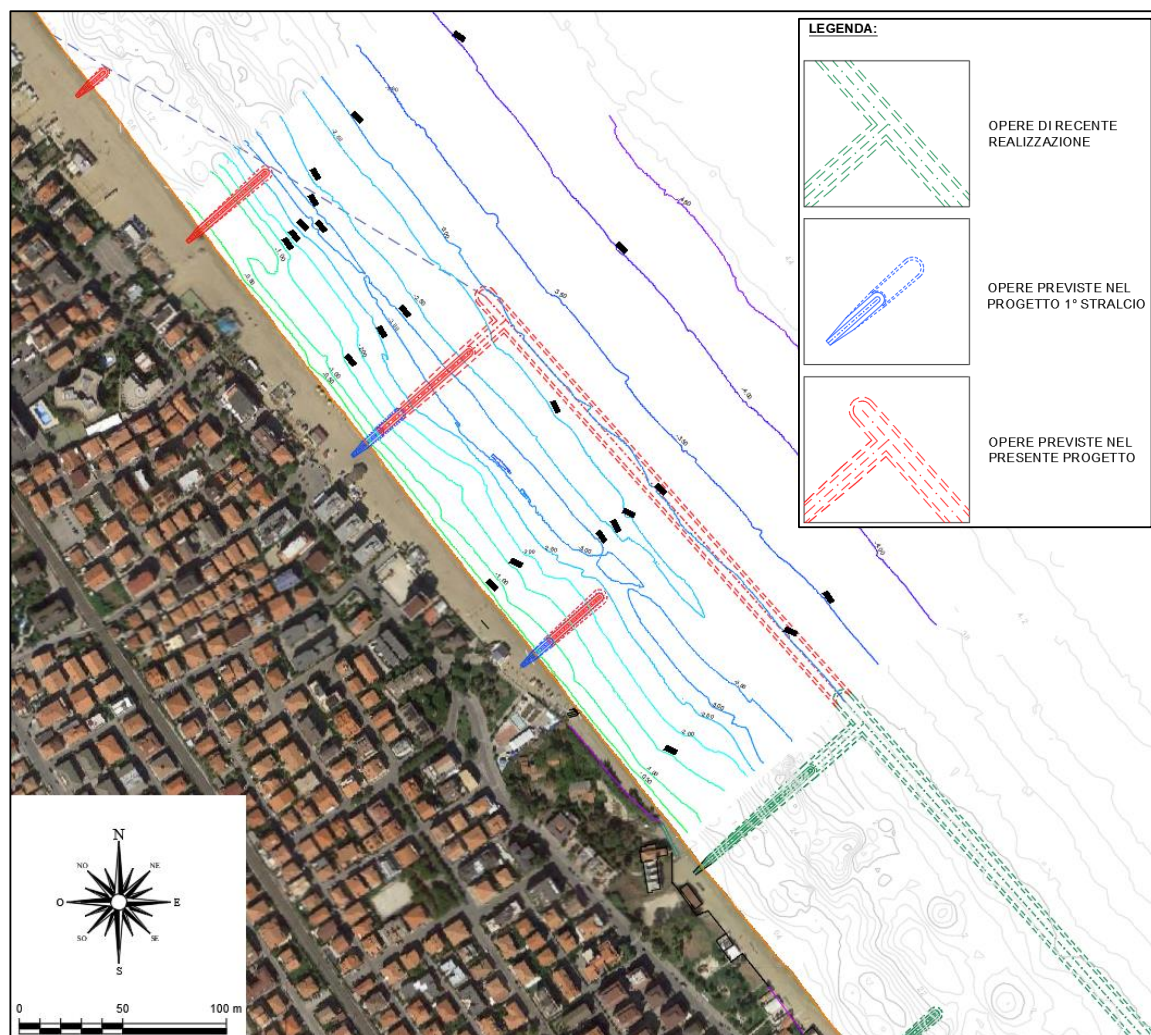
Planimetria con l'indicazione delle opere in progetto sovrapposte a quelle di recente e di prossima realizzazione.
